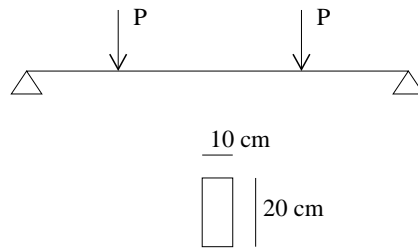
Shéma de chargement de la poutre sur 2 appuis.
